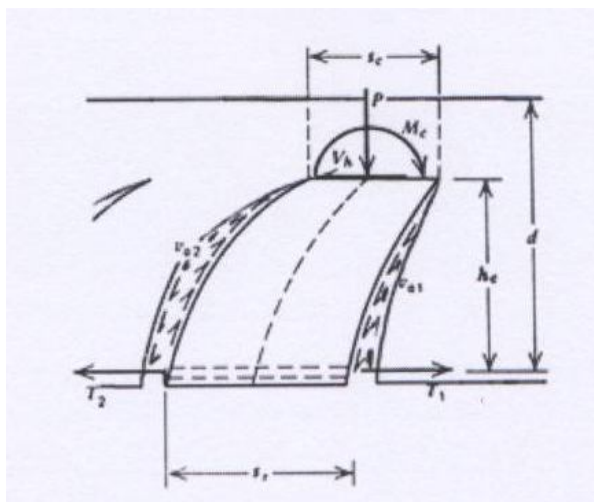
Voladizos de hormigón (Adaptada de Park y Paulay [20].).
